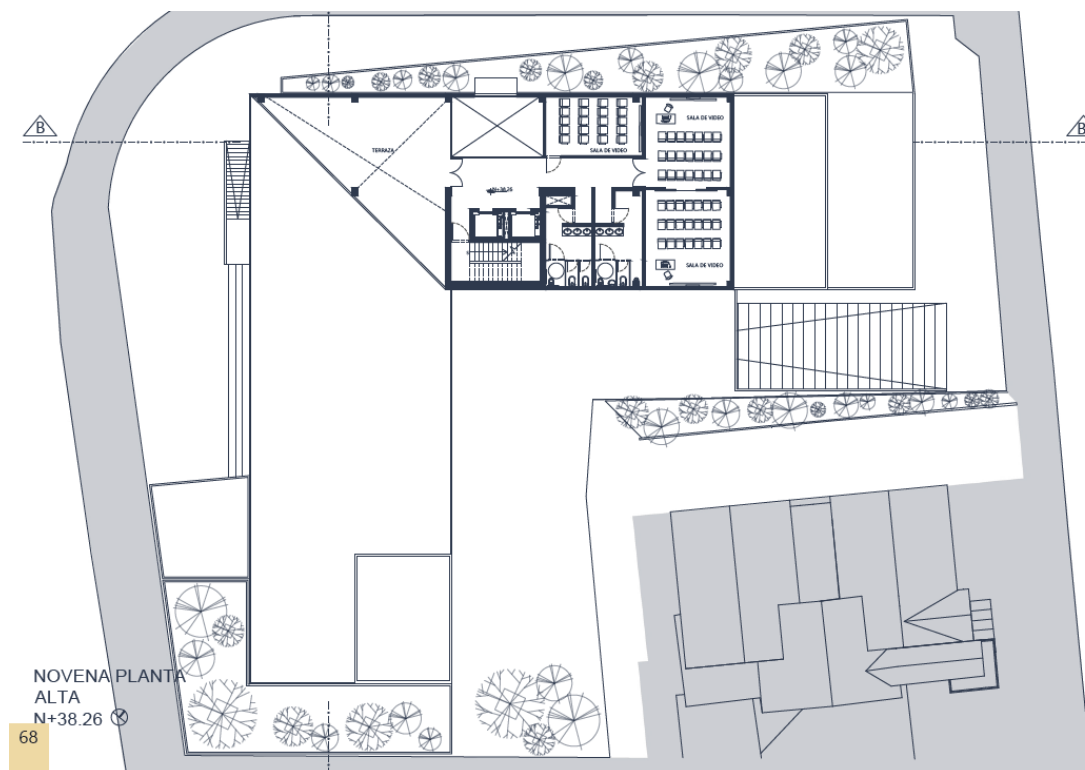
Novena Planta Alta N+38.26. Autoría propia
